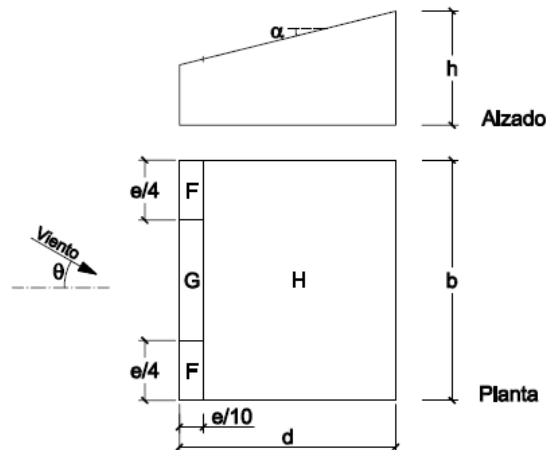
Zonas de la cubierta de la nave adosada para viento transversal 0° .
